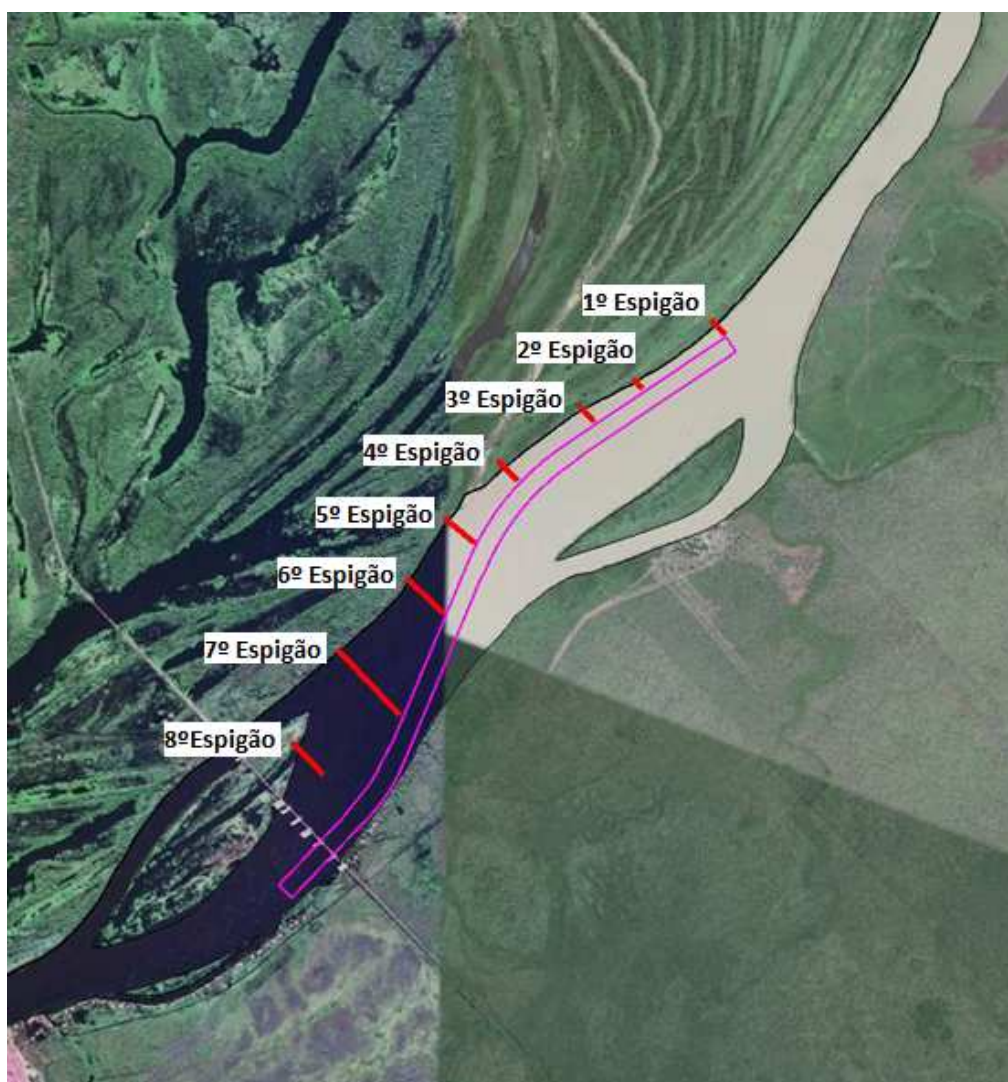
Croqui da localização da 1ª configuração de espigões ao longo da área de estudo.
